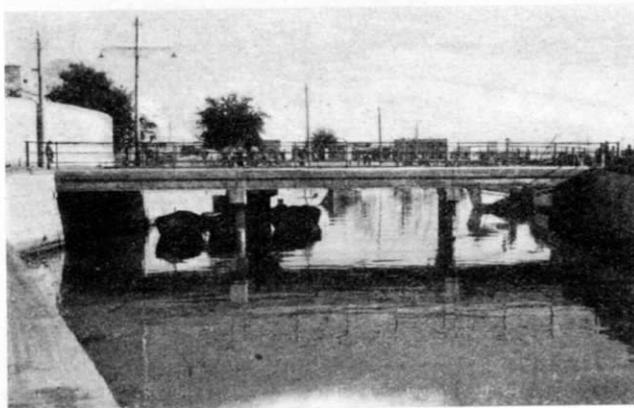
Vista del ponte dell'ospedale sul canale di Terracina.
